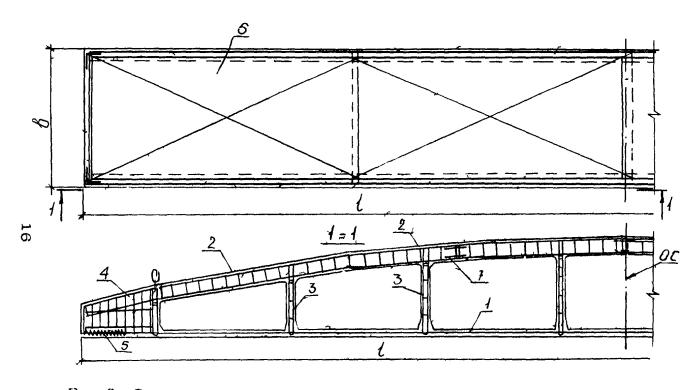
Схема армирования складчатой панели-оболочки КСО
